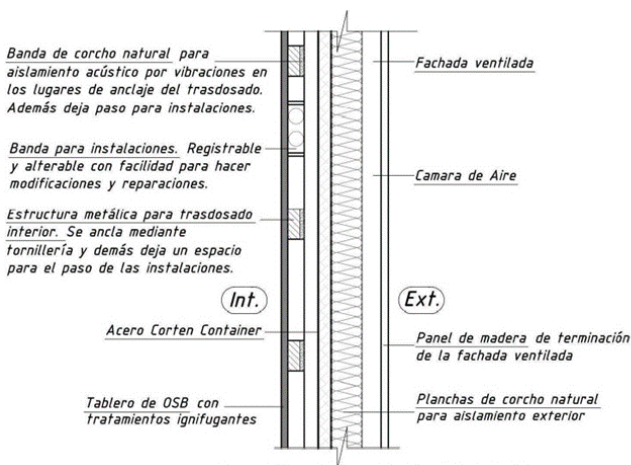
Detalle constructivo de aislamiento por cara exterior según solución adoptada. Fuente: Elaboración propia.
